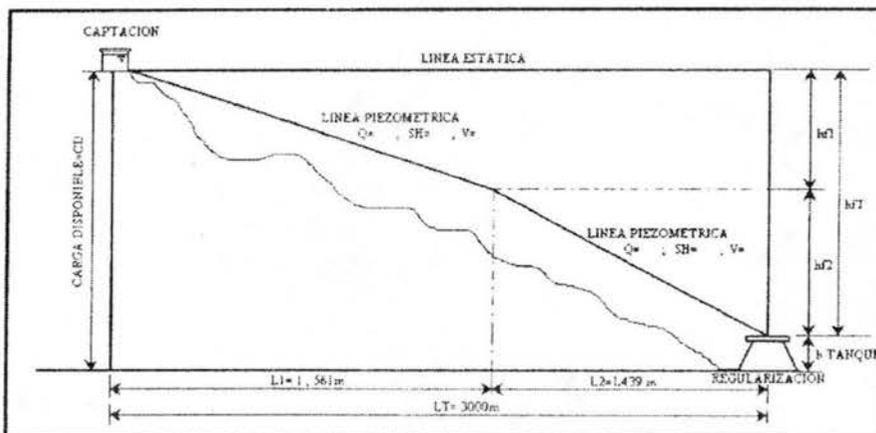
Pérdidas de fricción en una línea de conducción
